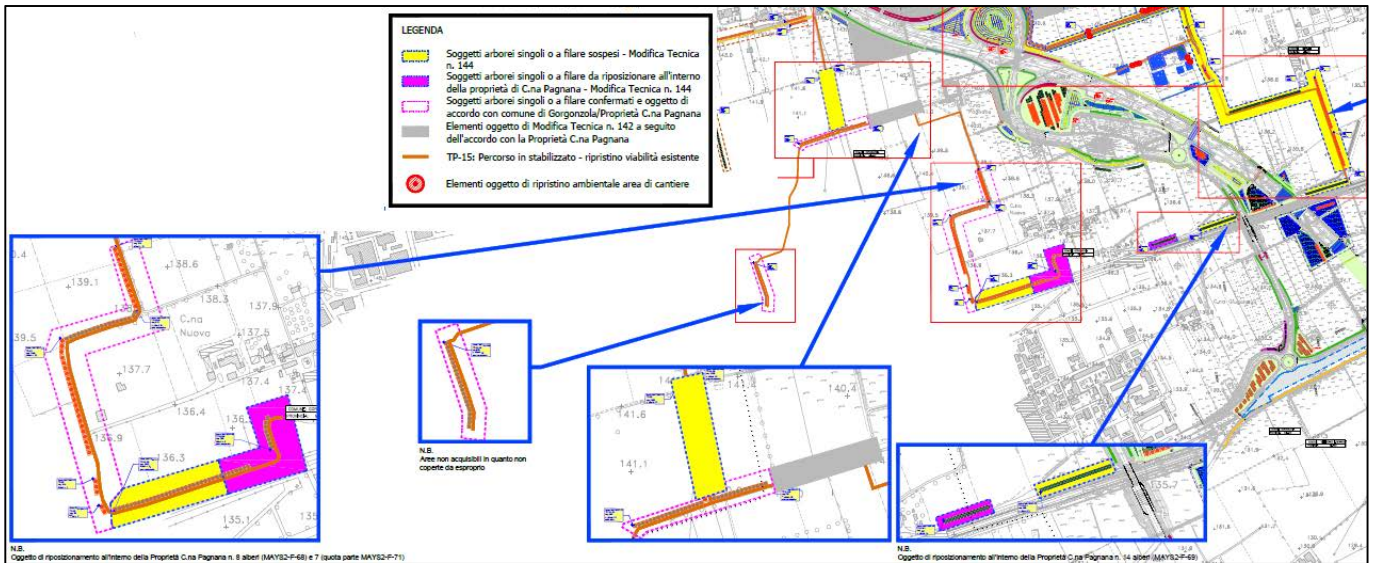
Stralcio planimetrico filari a sud di TEEM
